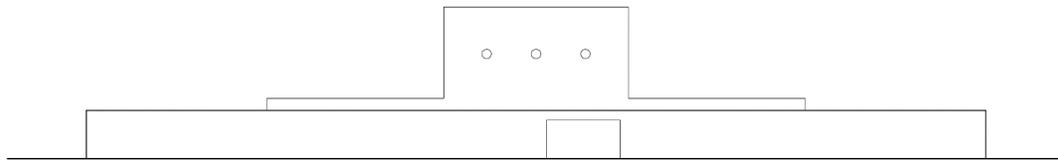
Planta Guardería Benetton (Italia 2007)
